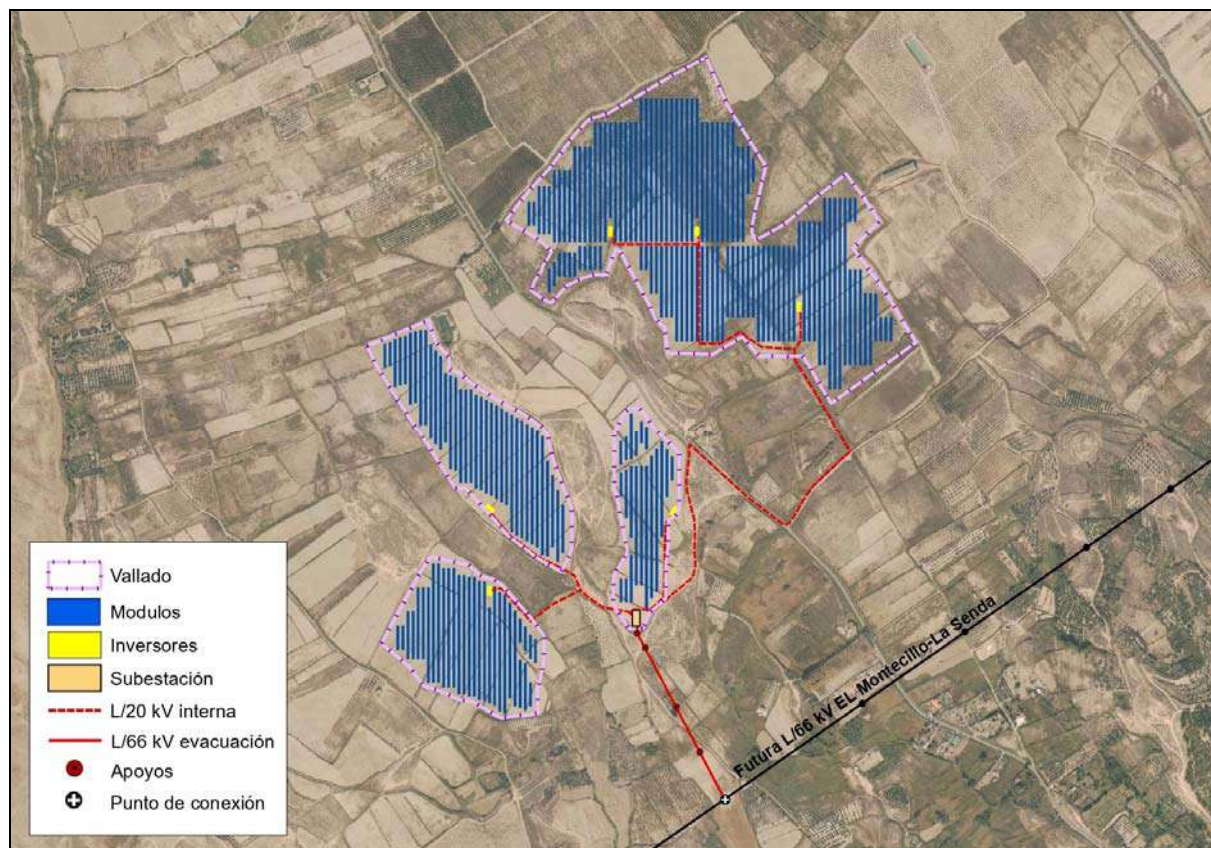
Implantación definitiva para instalación de planta solar fotovoltaica y línea eléctrica de evacuación
